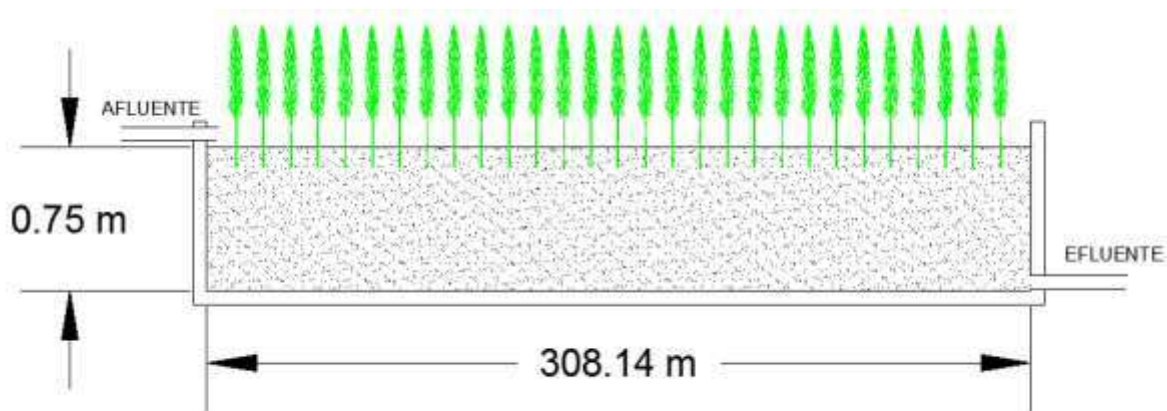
Vista en alzado de humedal artificial de flujo sub-superficial.
